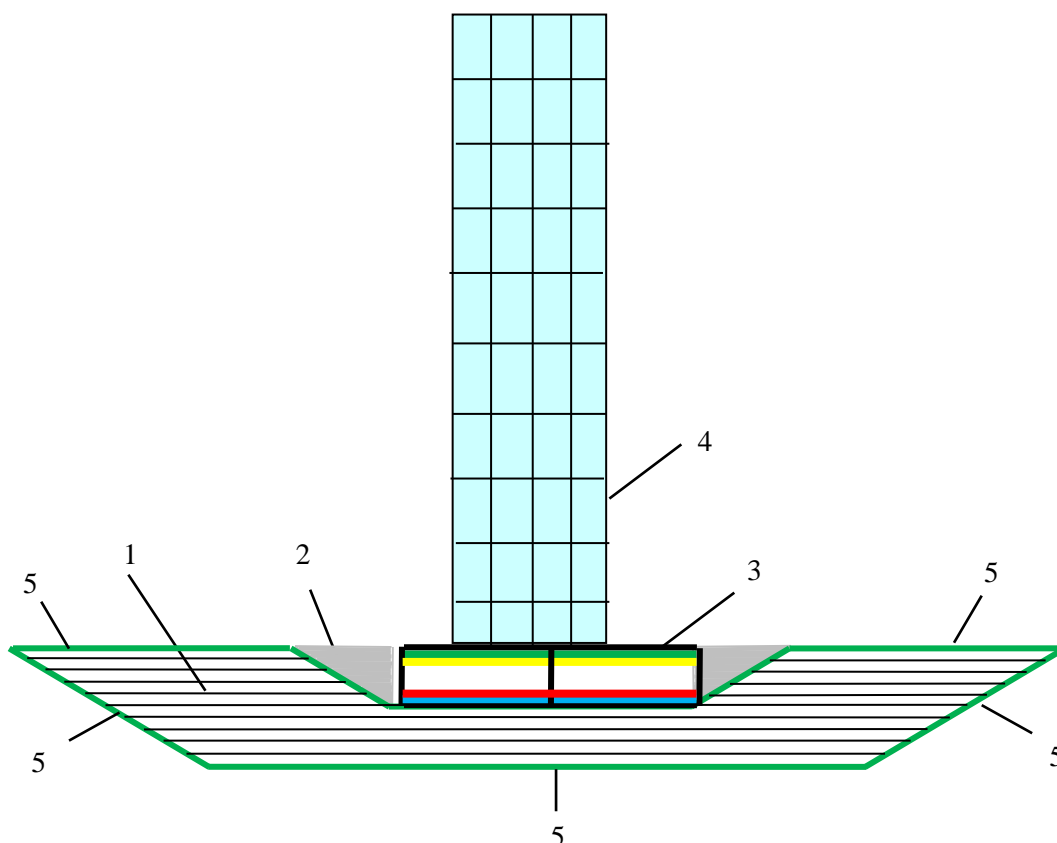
Конечно-элементная модель расчетной схемы задачи «здание — фундамент — слоистое грунтовое основание»: 1— Горизонтально слоистые грунты основания; 2 — обратные засыпки; 3 — фундамент; 4 — здание; 5 — внешние границы котлована.
